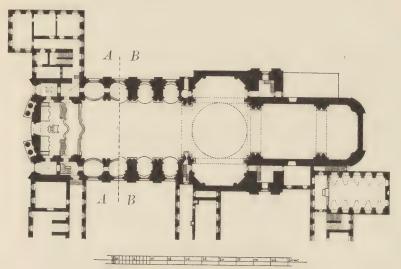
Klosterkirche zu Zwiefalten. Grundriss A. des Obergeschosses, B. des Erdgeschosses.
